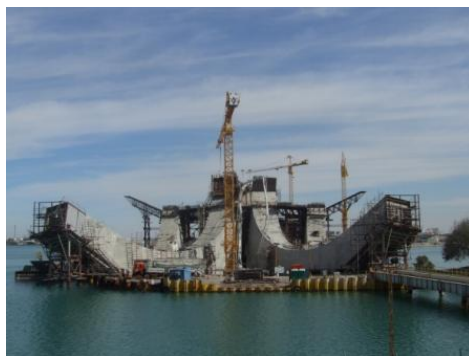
Sheik Zayed Bridge, Abu Dhabi [26]
